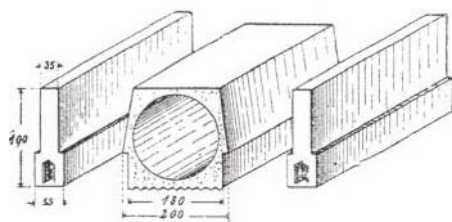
Systeemvloer bestaande uit betonnen elementen [1]
